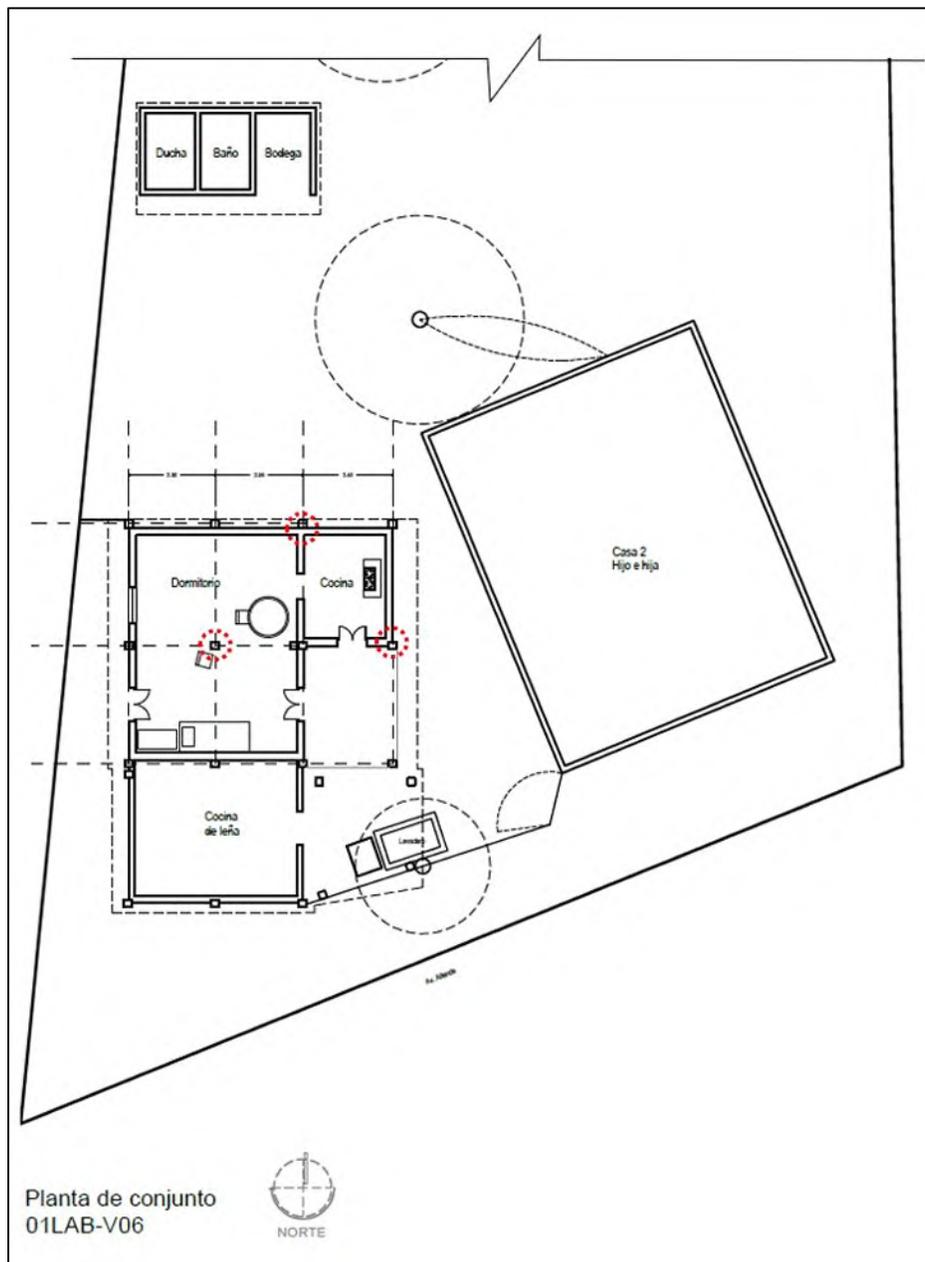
Planta de conjunto de vivienda 01LAB-V06. Círculos rojos representan horcones sustituidos por pilares de concreto. Fuente: elaboración propia.
